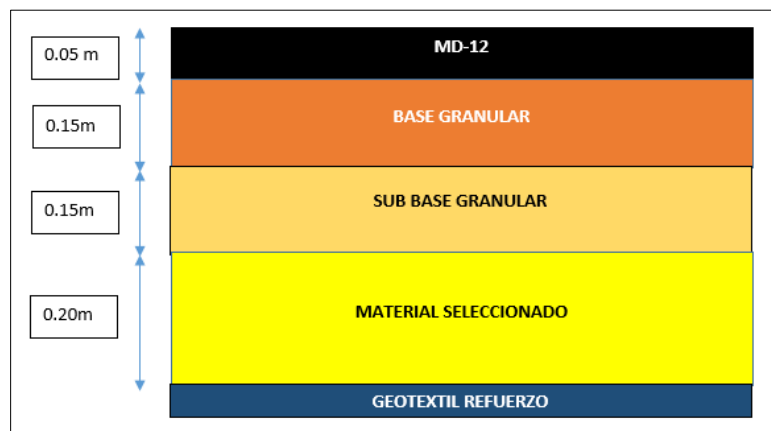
Estructura Pavimento con materiales pétreos. Estructura 1
